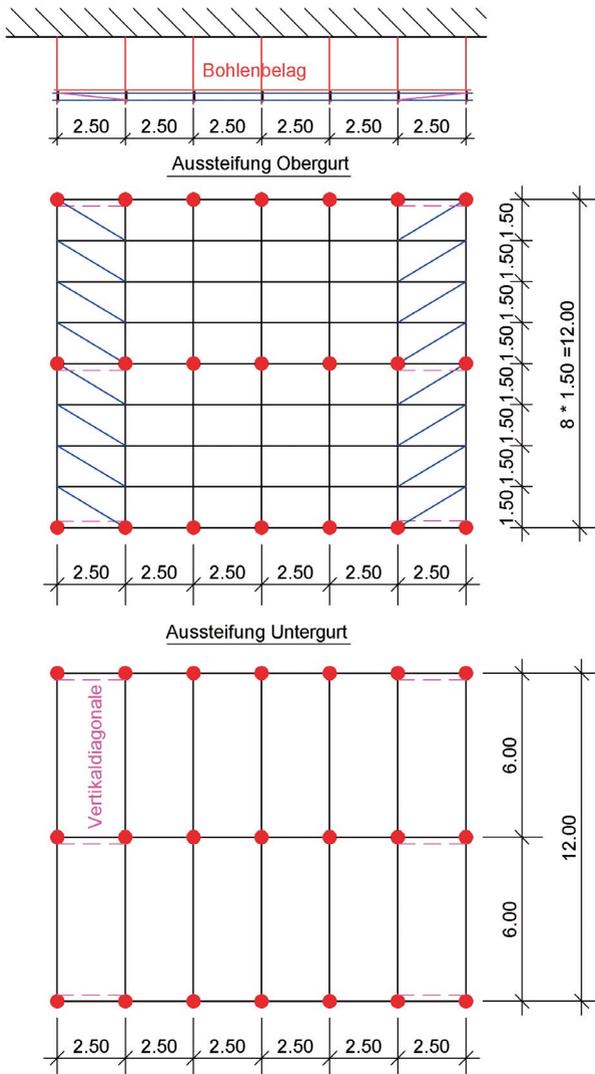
Regelausführung von Hängegerüsten mit Stahlrohr-Gitterträgern, Bauhöhe 450 mm (Aussteifung der Gitterträger)
